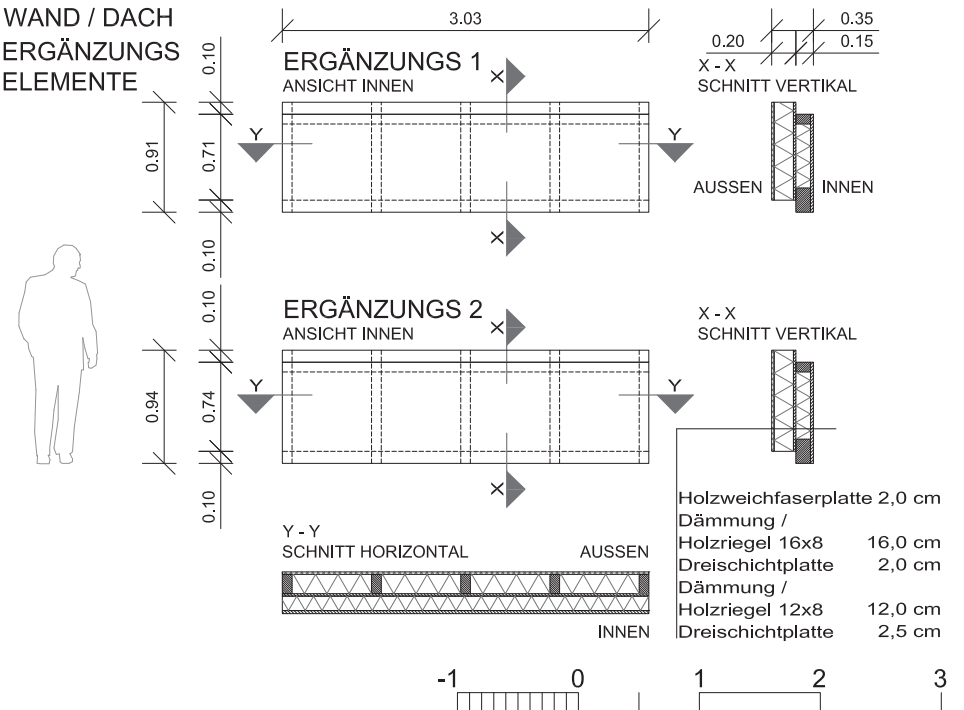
| Wand / Dachergänzung Ansicht und Schnitt
